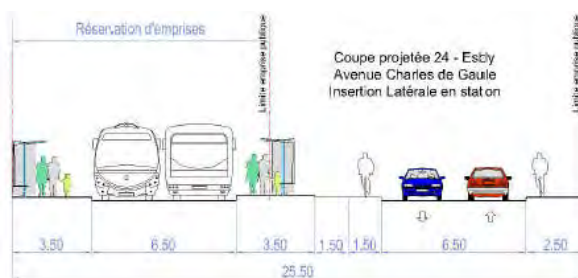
Coupe projetée au niveau de la station du TCSP sur l'avenue du G^{al} de Gaulle en amont du pont sur le canal – source : SYSTRA
